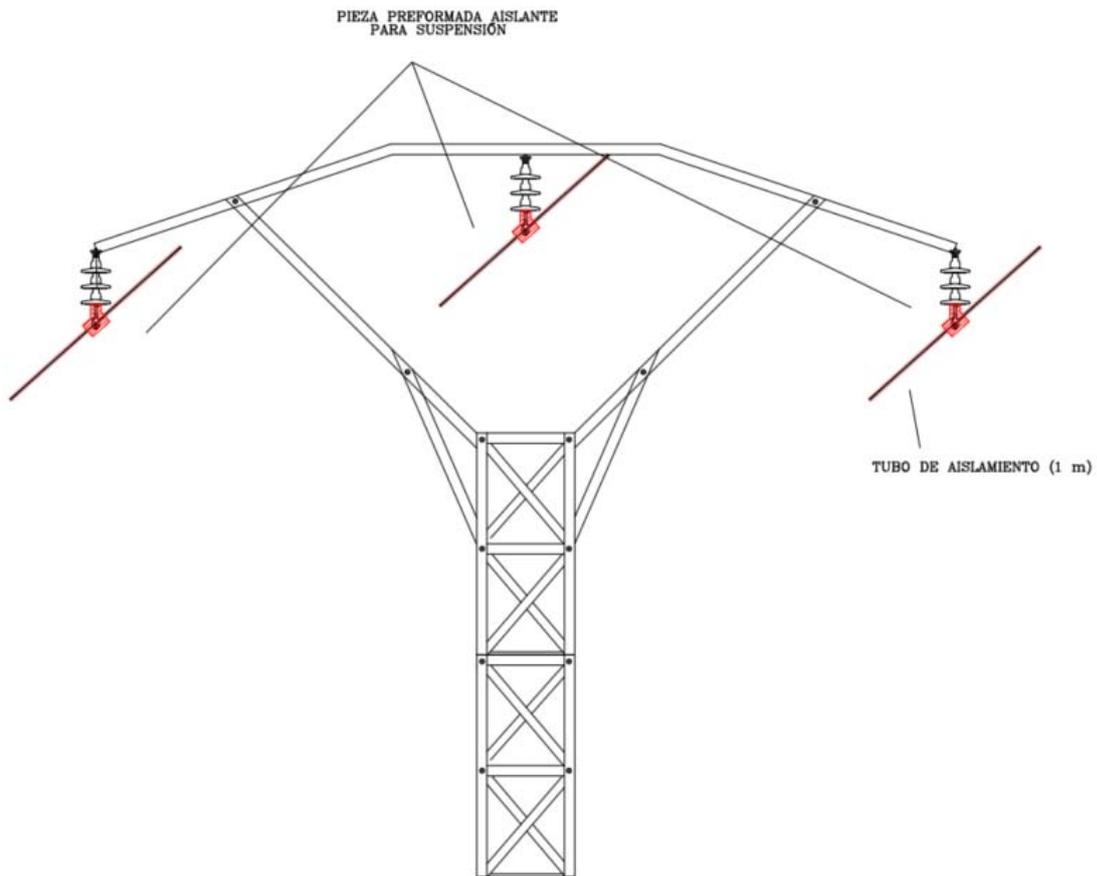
Apoyo tipo bóveda con cadenas de suspensión y aislamiento de las tres fases
